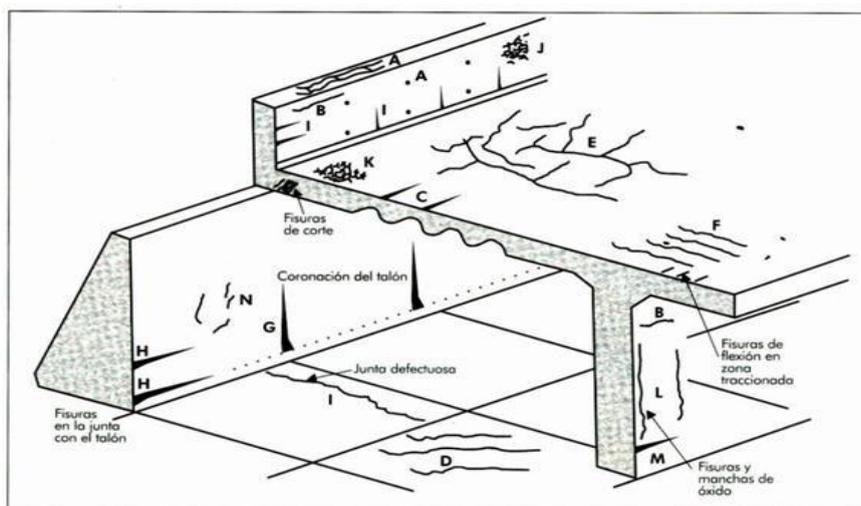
19 ESQUEMA DE UBICACIÓN DE LOS DIFERENTES TIPOS DE FISURAS
